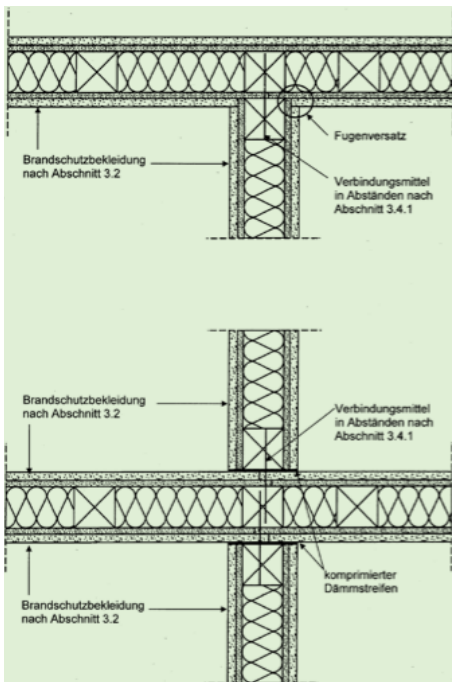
Anschluss von tragenden, raumabschließenden Wänden an durchlaufende Wand mit zusätzl. Stiel zur Sicherung der Verblockung nach der M-HFH-HolzR
